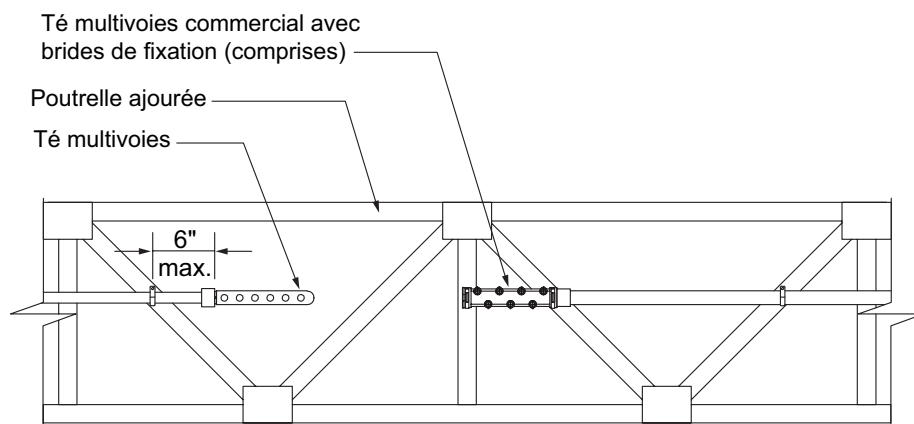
Support de tés multivoies sur des poutrelles de bois ajourées
